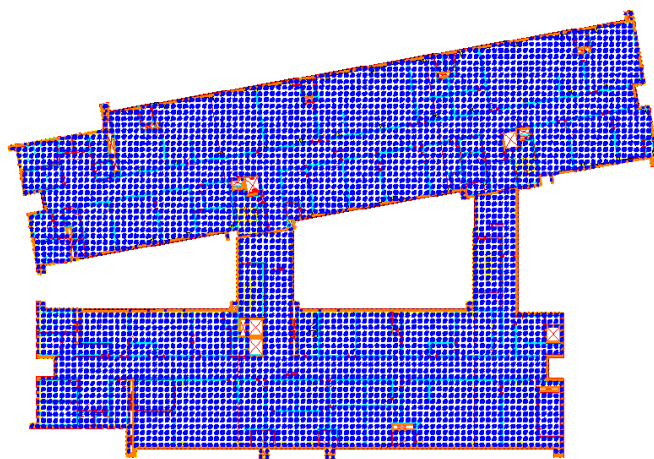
Área considerada para pavimento tipo (4º Pavimento)
